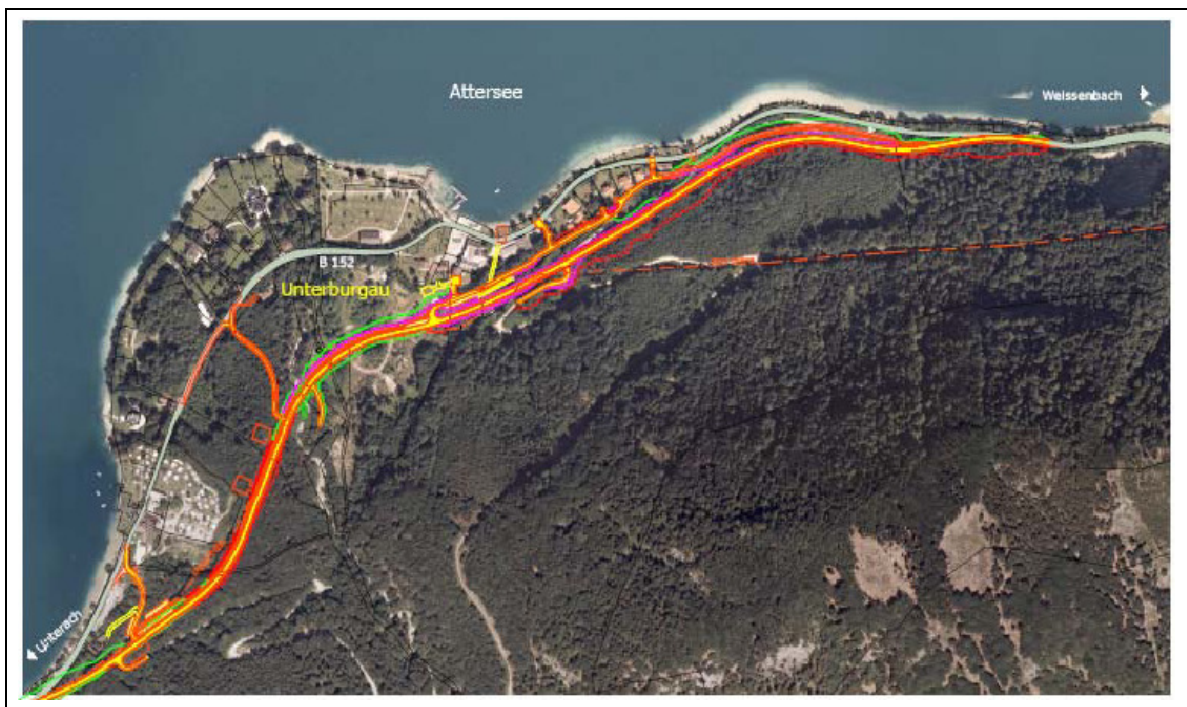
Plan zur Neutrassierung der Landesstrasse (Quelle: Architekturbüro Köck, Planungsstand 27.3.2007, 5020 Salzburg)
